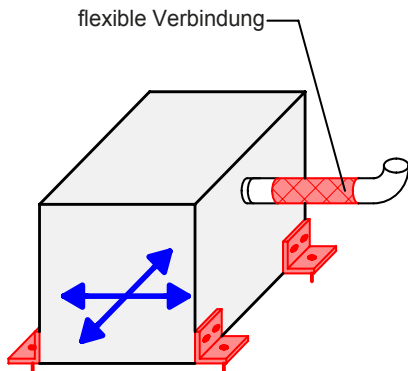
> Befestigung der Installation mit Stahlwinkel
